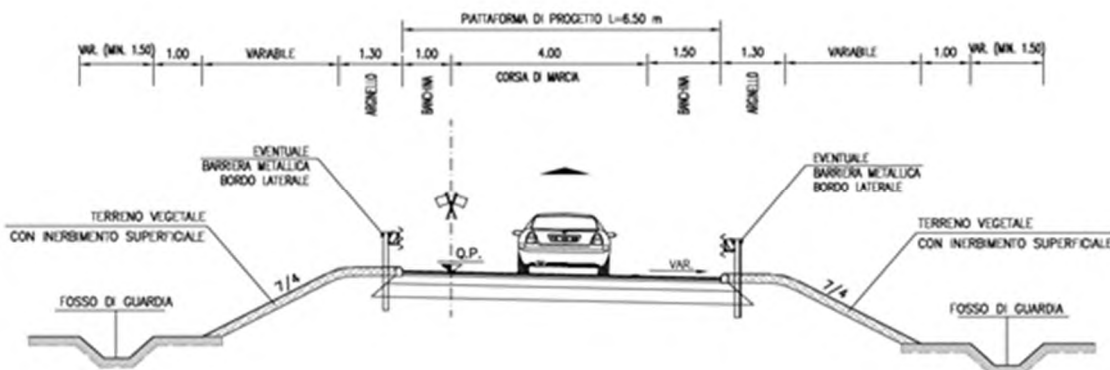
Sezione tipo rampa di svincolo monodirezionale
